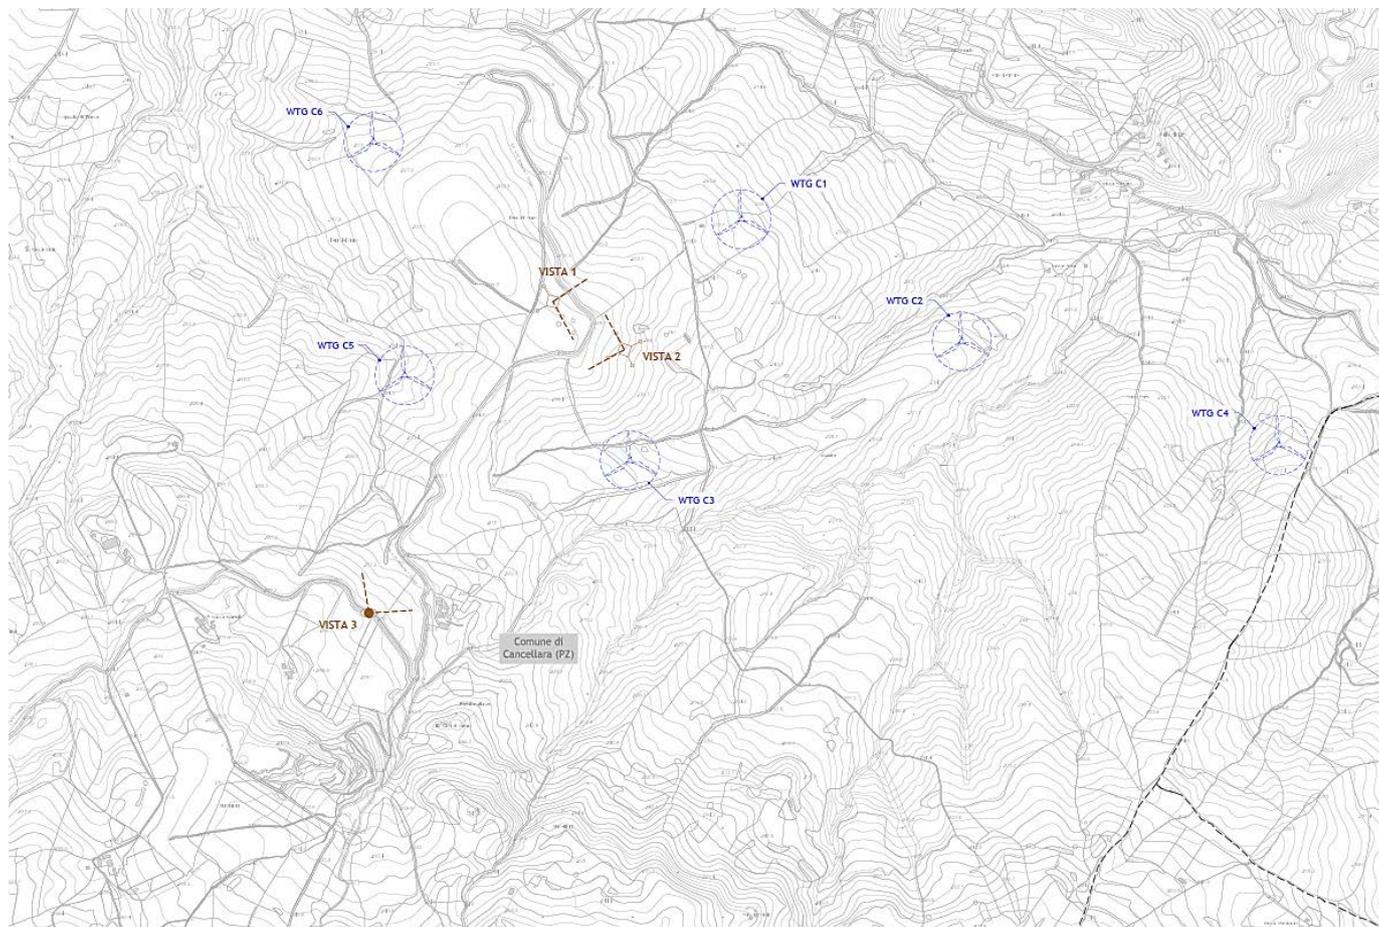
Planimetria generale aree oggetto dell'intervento, Impianto Eolico
